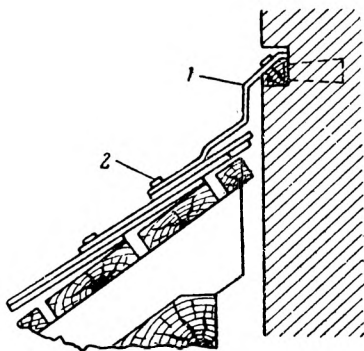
Примыкание кровли из асбестоцементных плиток к каменной стене:
